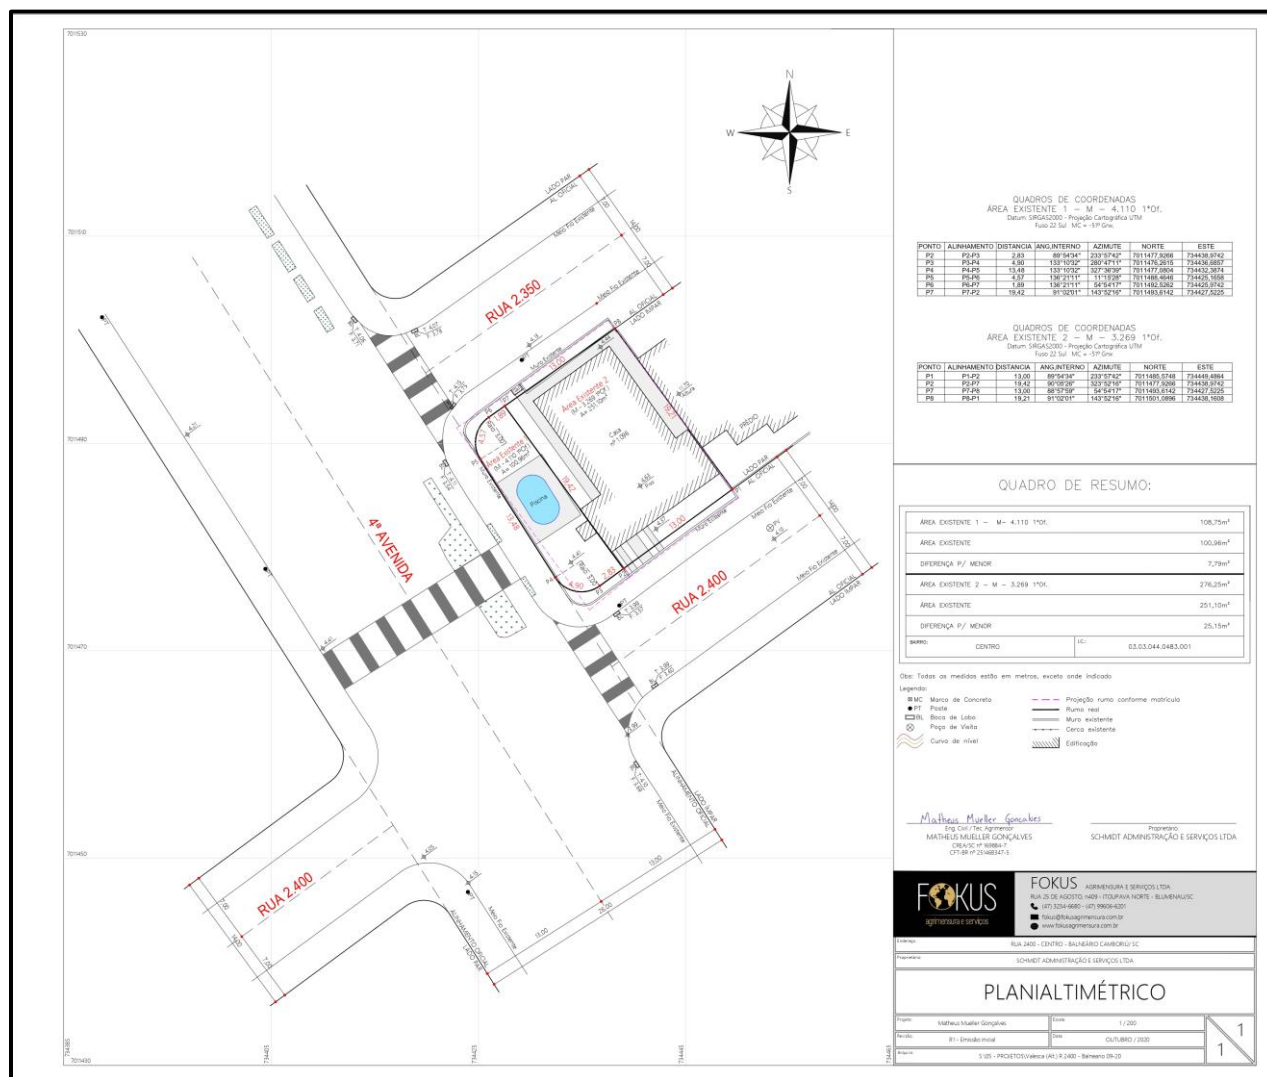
Planta Planialtimétrica Sicoob (Fonte: Fokus Agrimensura)
